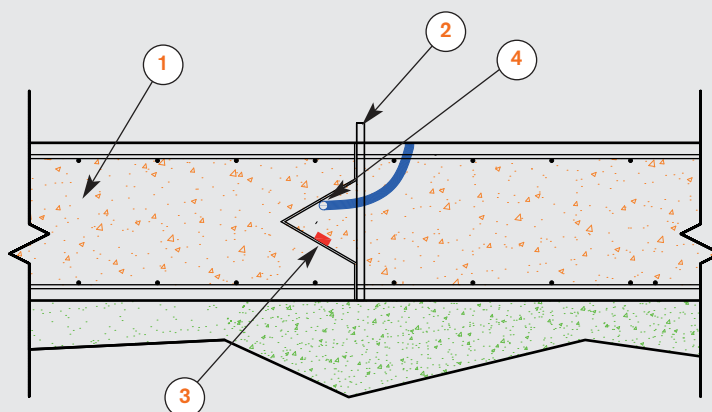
PLATEA - GIUNTO DI RIPRESA (A) (ogni 800 - 1000 mq) con ws valve injection
